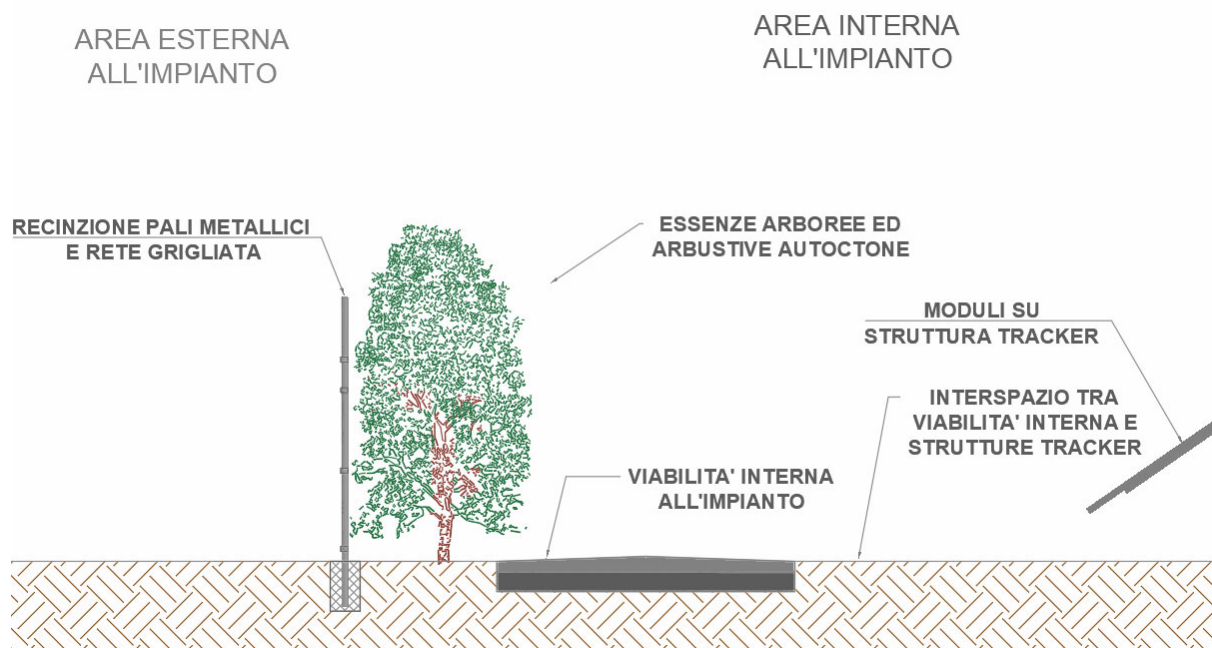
Sezione A-A relativa al dettaglio di planimetria dell'area nei pressi della recinzione: rappresentazione degli spazi nell'area interna all'impianto
